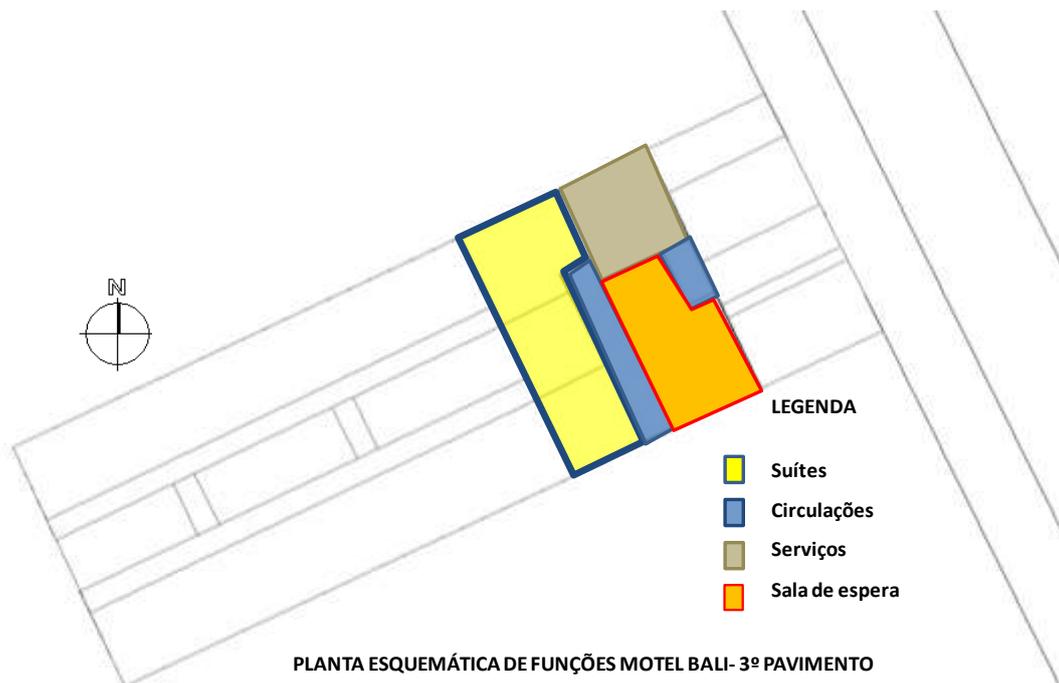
Planta esquemática de funções do 3º pavimento do Motel Bali (AUTORA, 2010)
